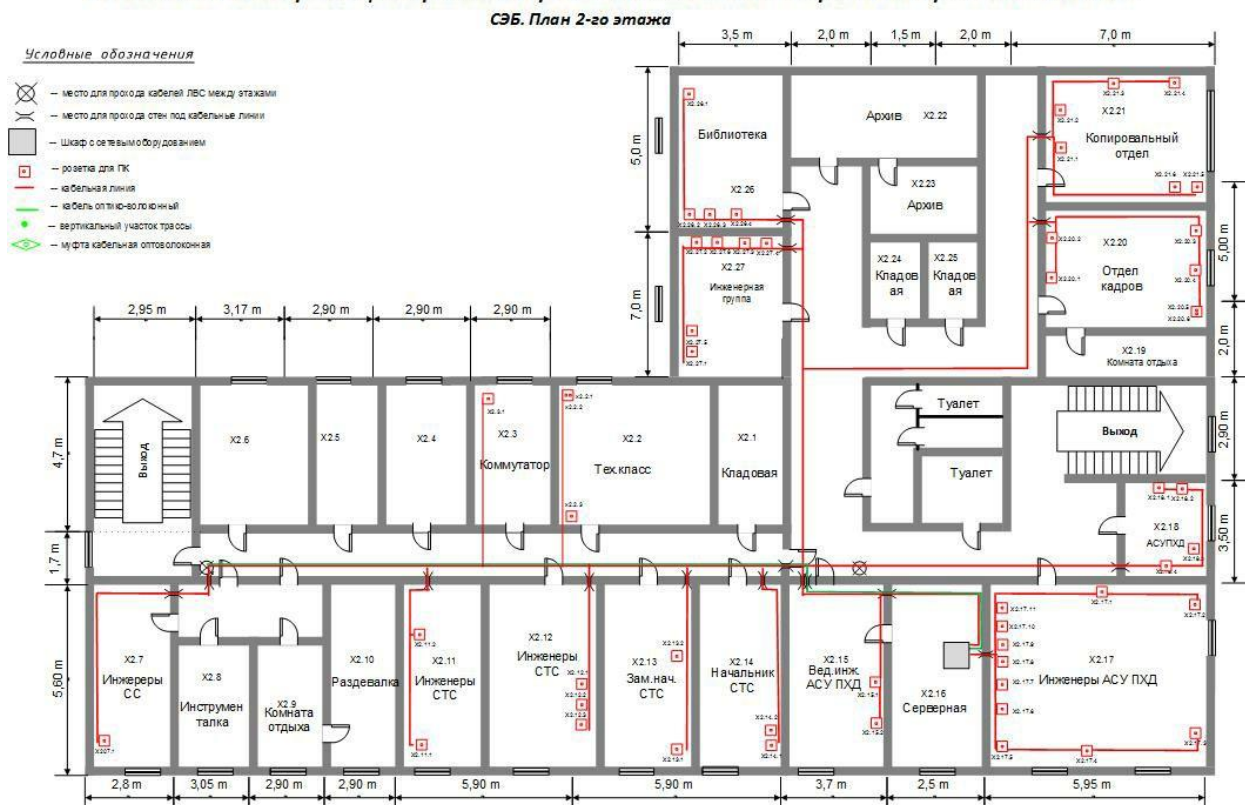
Схема прокладки СКС (2 этаж)
